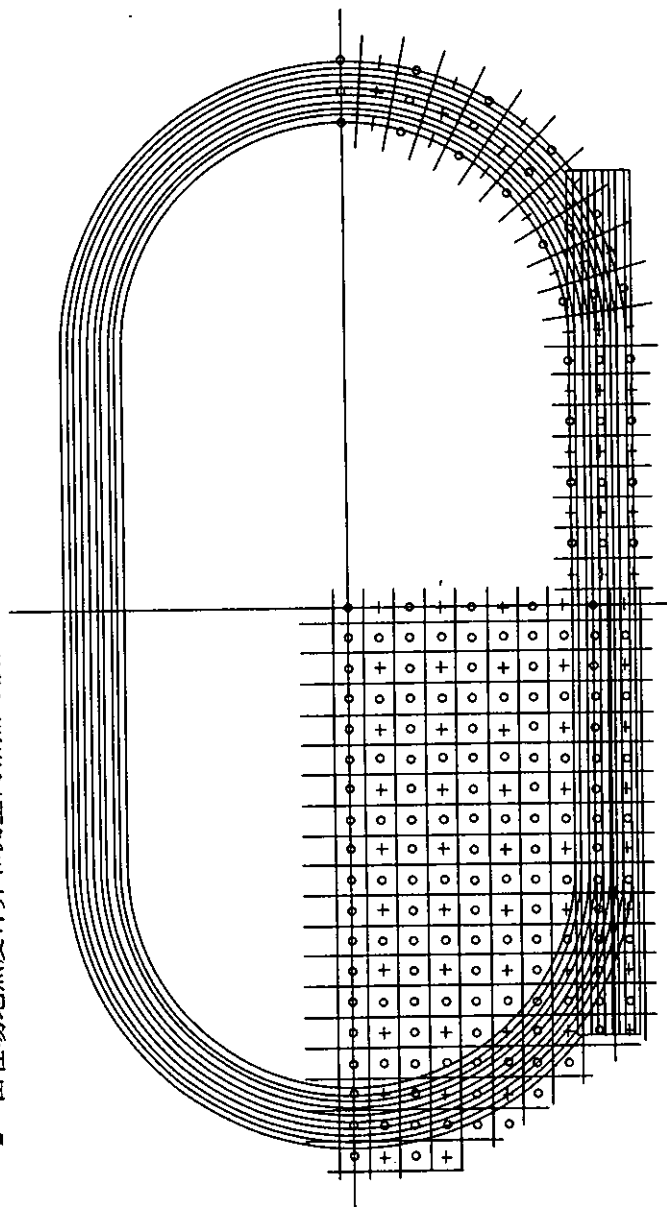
田径场地照度计算和测量网格点布置图
